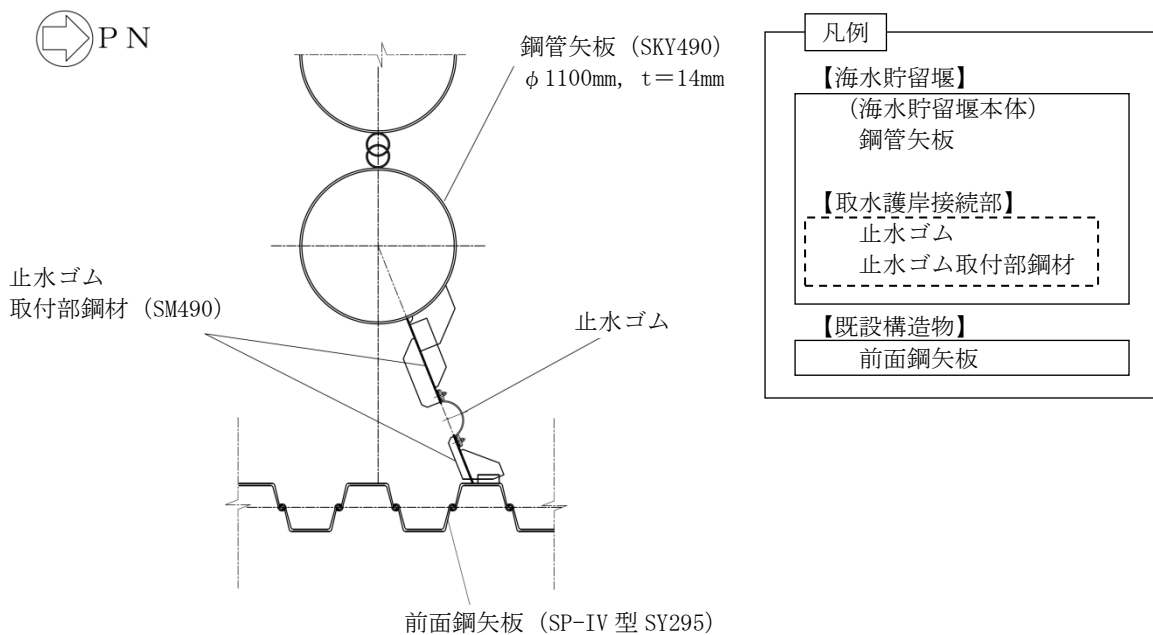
(2) 取水護岸の平面図 (A部拡大)
